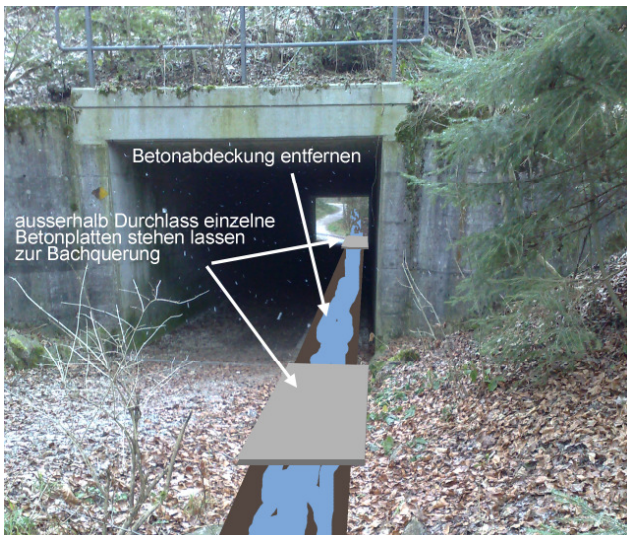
Bachdurchlass unter Autobahn (Massnahme GD1)
